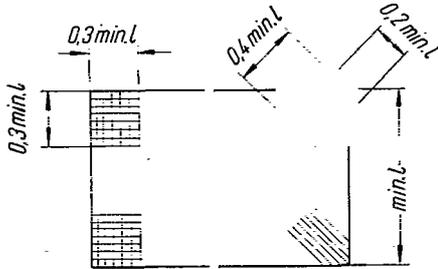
Rechtwinklige und schräge Eckbewehrung, Oberseite
